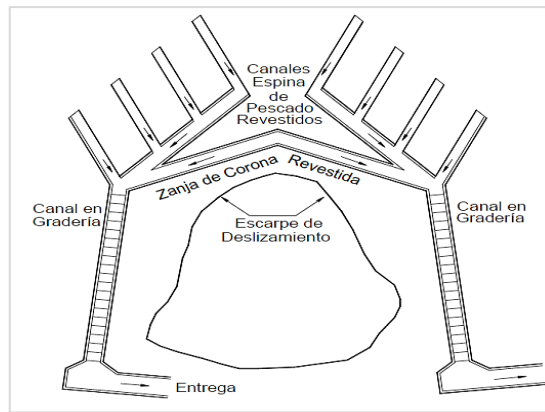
Esquema en planta de canales colectores Espina de Pescado.
